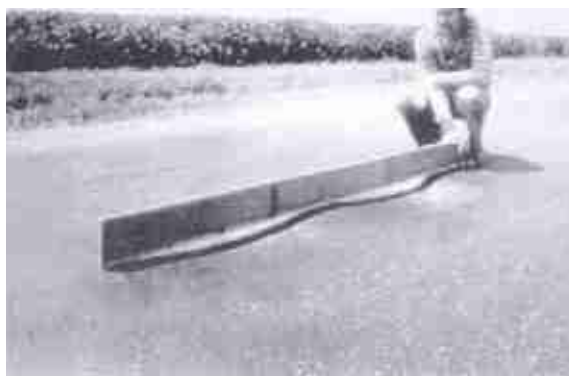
Falla Corrugación – Severidad Baja
